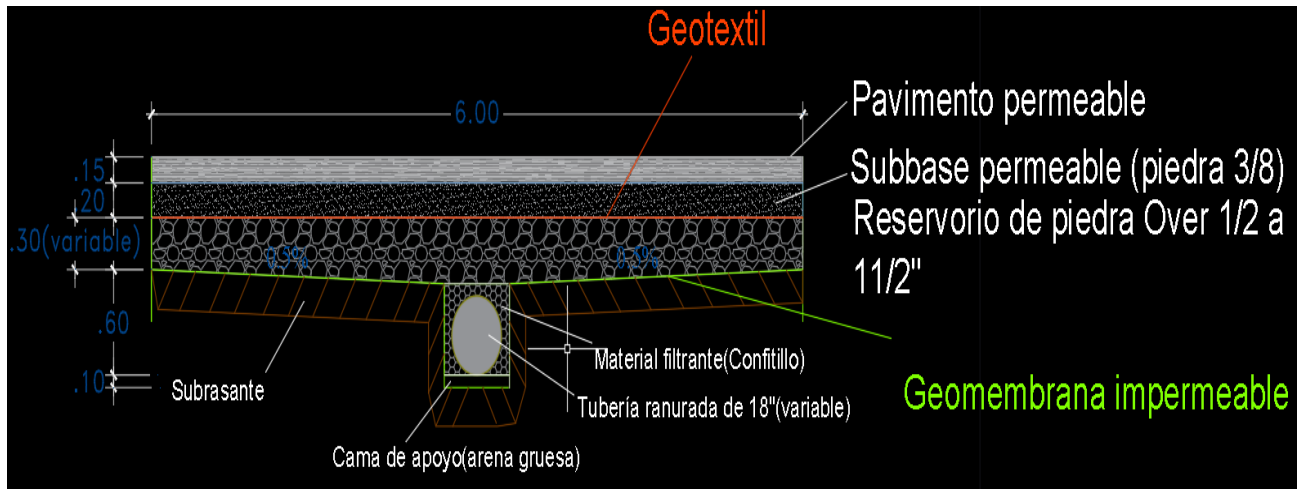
Detalle de pavimento permeable con sistema de drenaje
